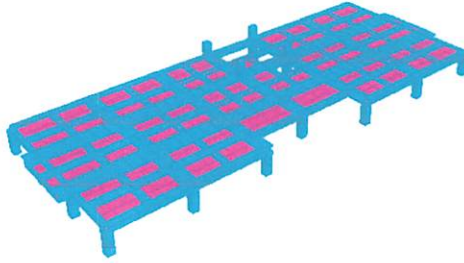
Pemodelan struktur lantai 8 pada STAAD Pro
